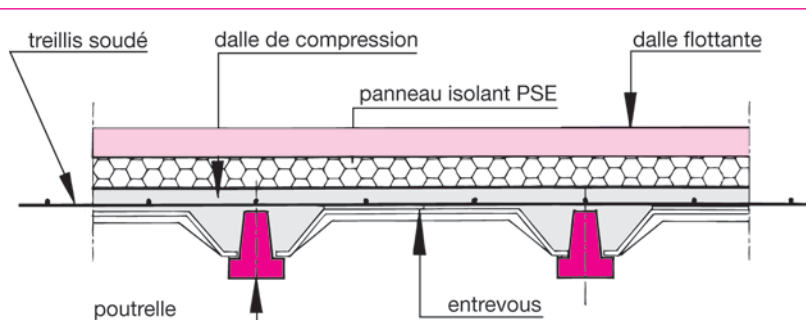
Plancher avec poutrelles précontraintes et entrevous en bois moulé
